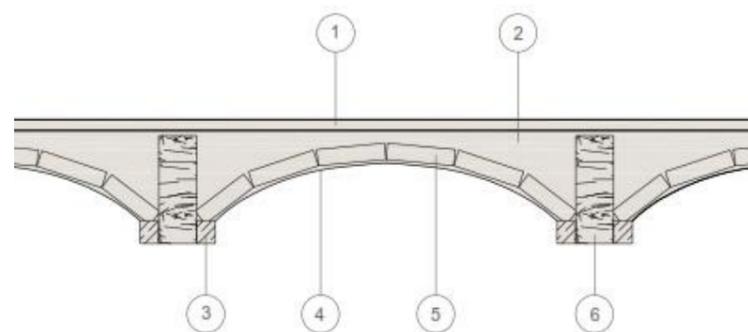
Detalle forjado de revoltón. Fuente: propia autora
